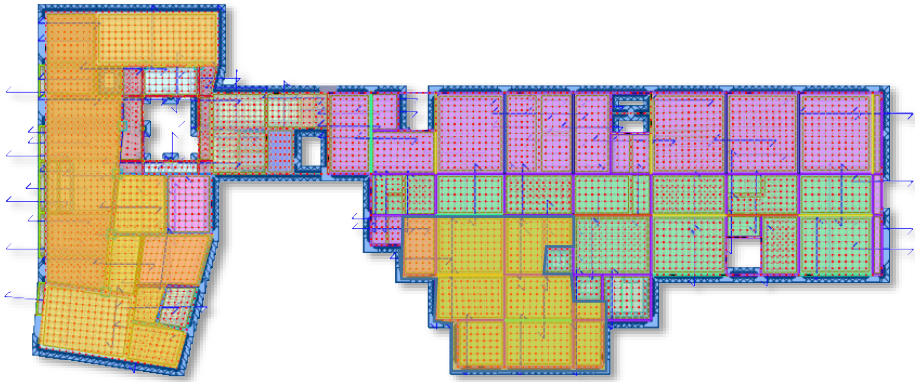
Planta con Sobrecargas (amarillo) de Almacén RSA.
